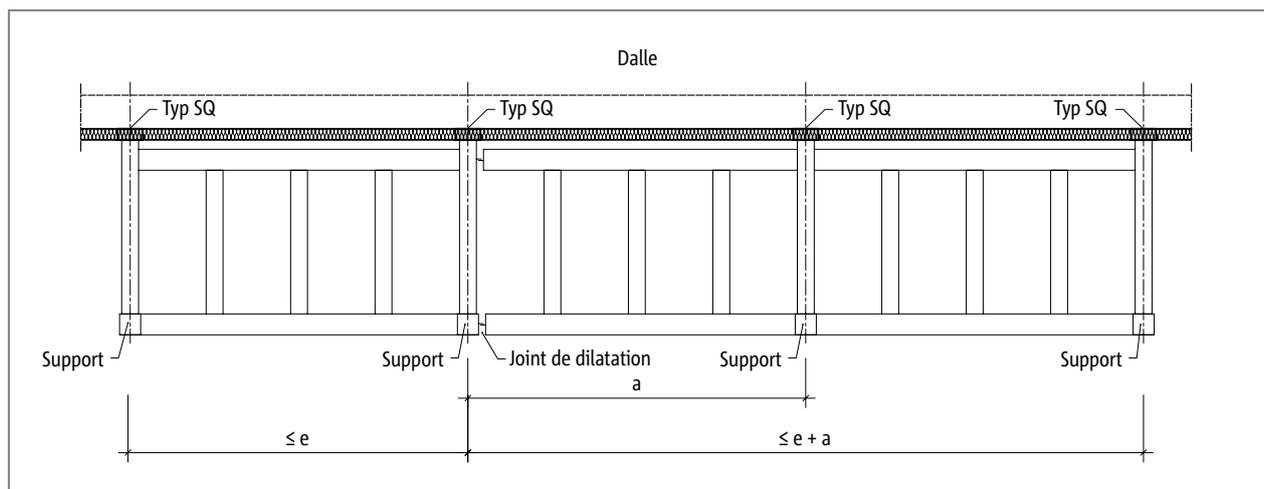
Schöck Isokorb® T type SQ : Distance maximale du joint de dilatation e et porte-à-faux latéral a
